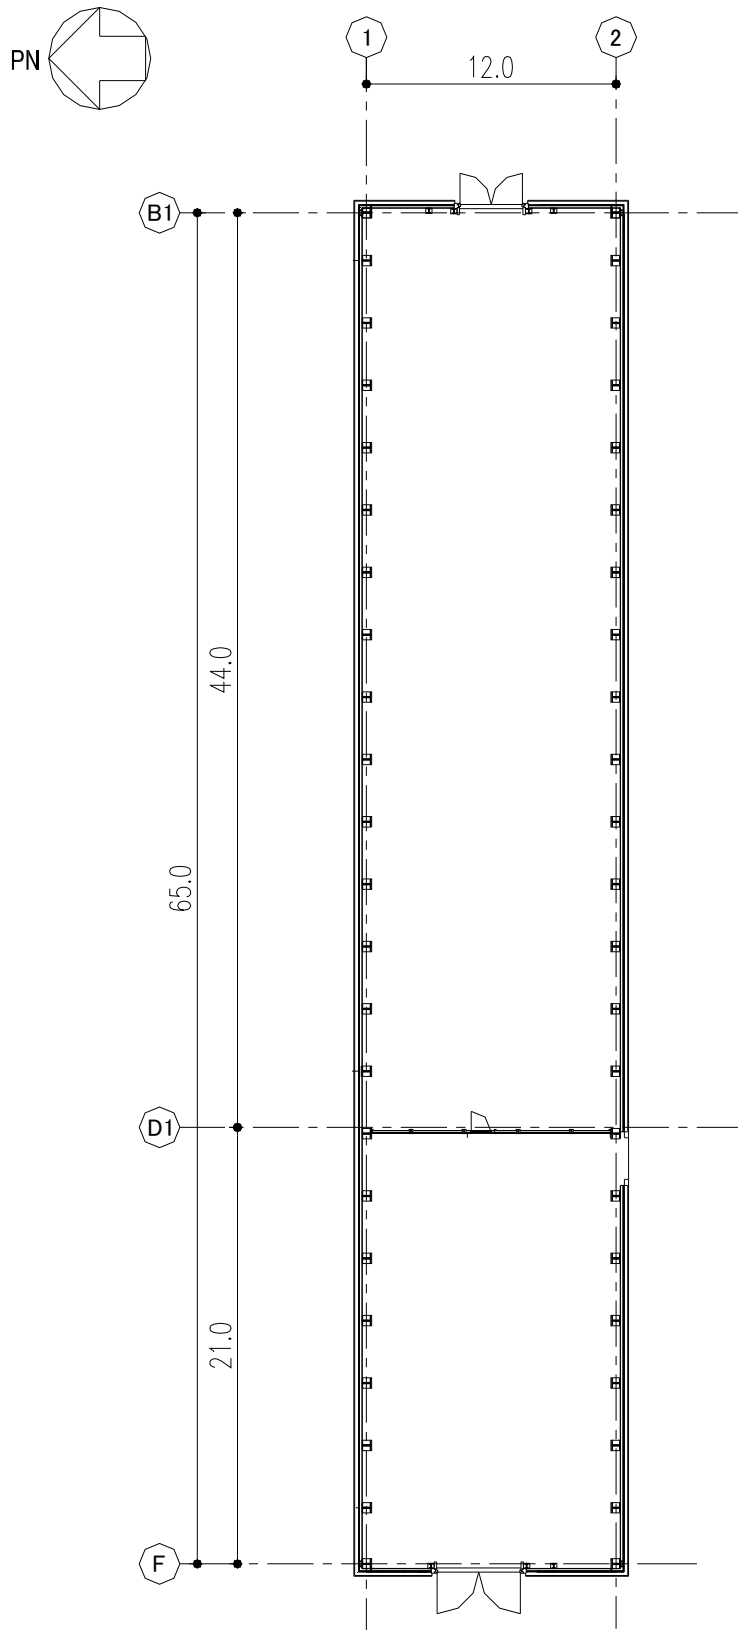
設備棟 建屋平面図 (O.P. 34.6) (単位 : m)
